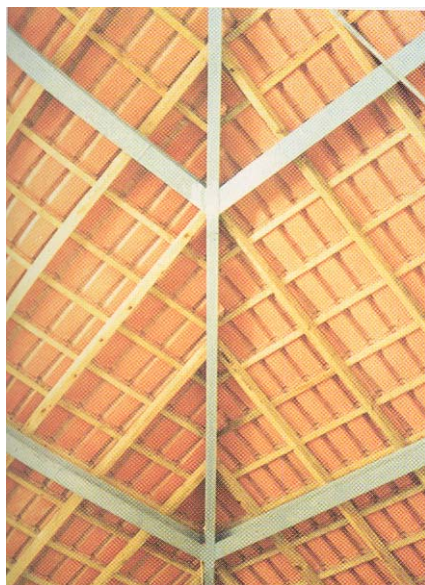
Estrutura principal metálica; contra-ripa e ripa em madeira
